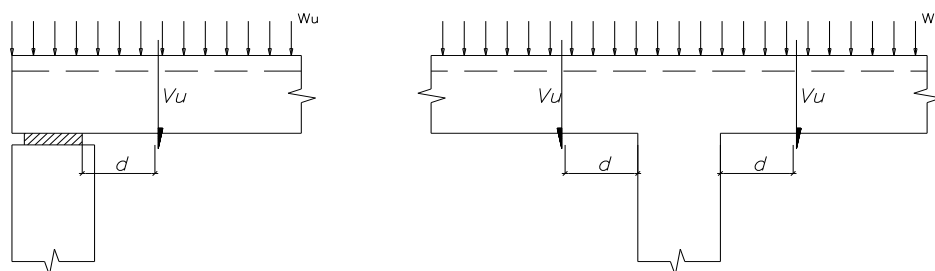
a Condiciones de apoyo y de aplicación de las cargas externas en las cuales se puede reducir la fuerza V_u de diseño a d de la cara.
